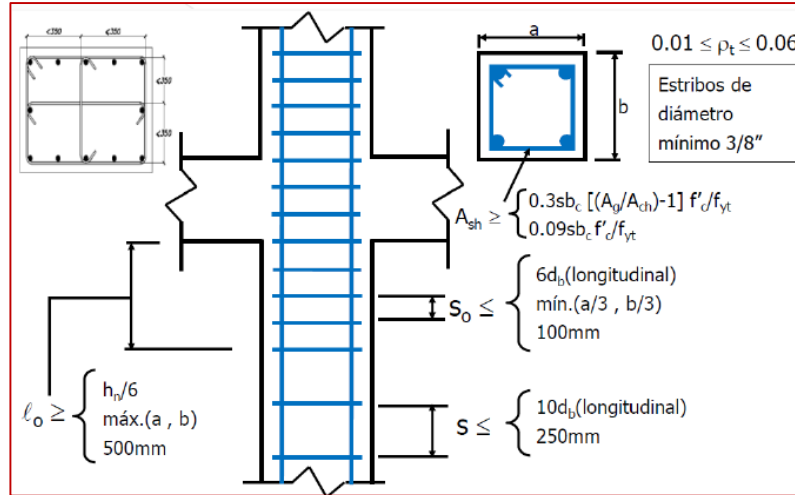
Espaciamiento de Acero Transversal en Columnas
